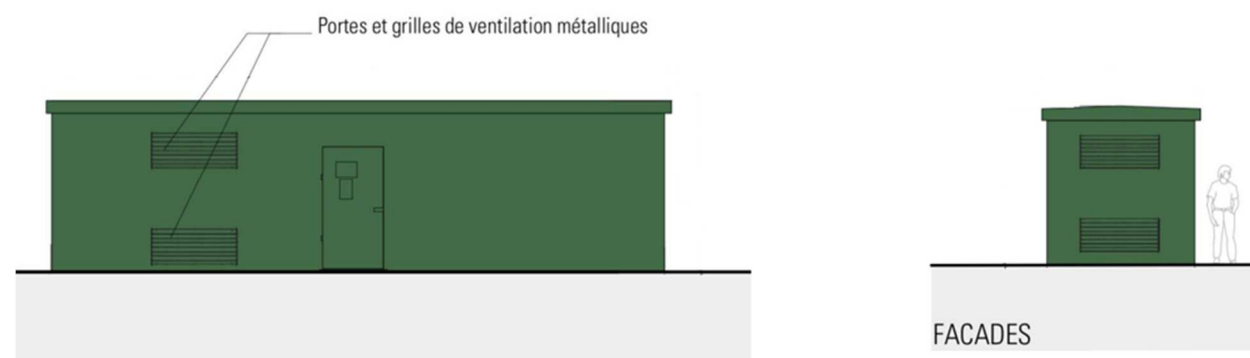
Vues des façades du poste de livraison prévu sur site (source : Solarvia)
